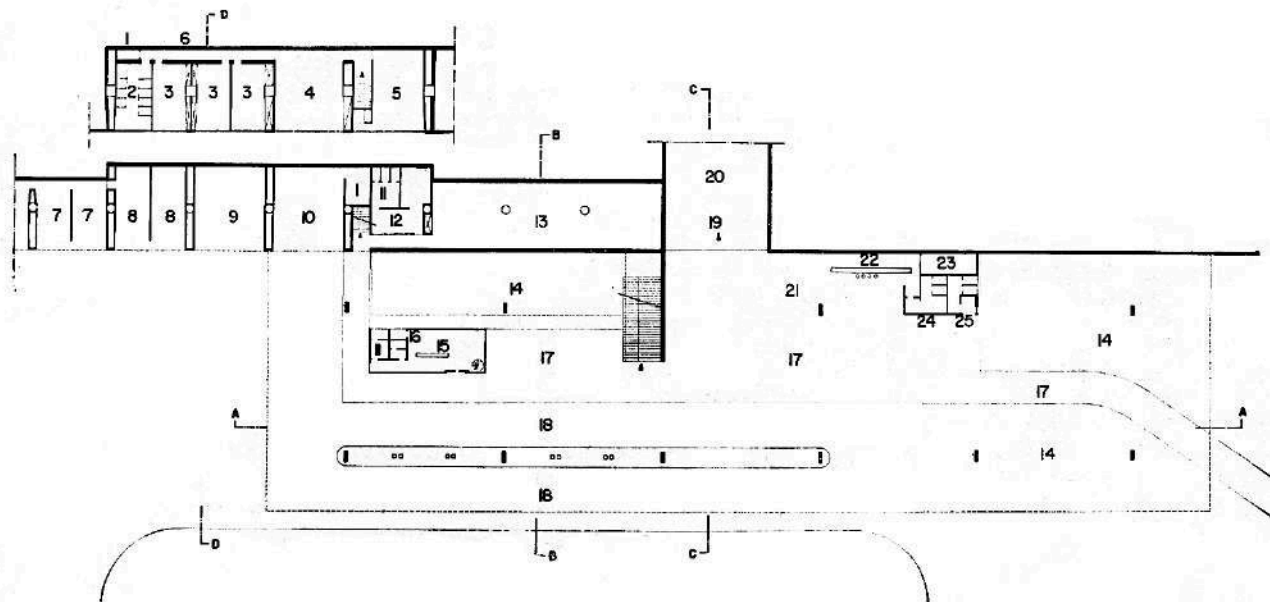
Planta de implantação da primeira proposta. Fonte: Revista *Módulo*, 1962.
